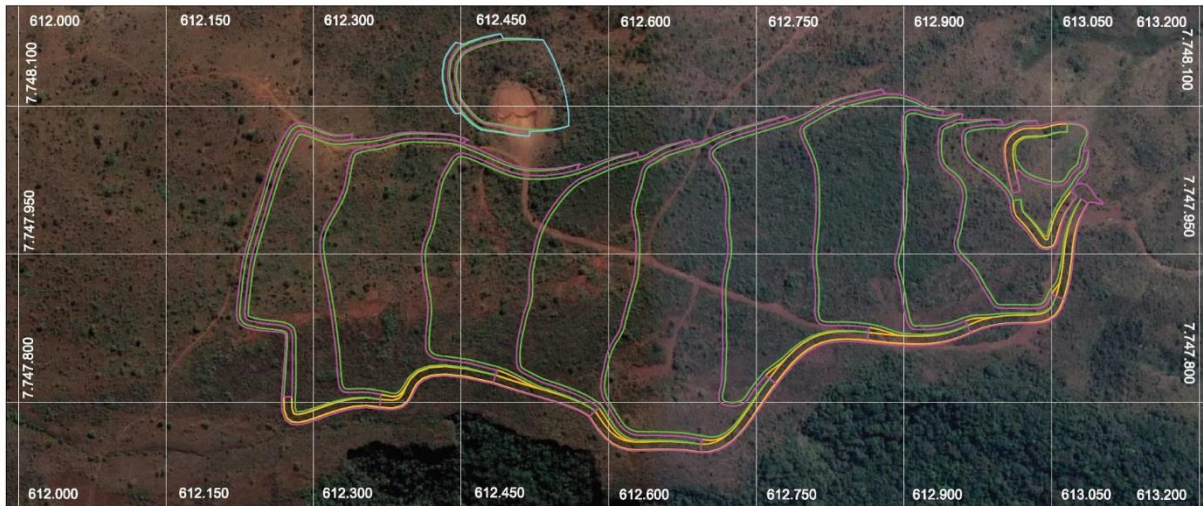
Planta da configuração final do pit de lavra de bauxita na Mina Bauxita, sobre imagem de satélite.
